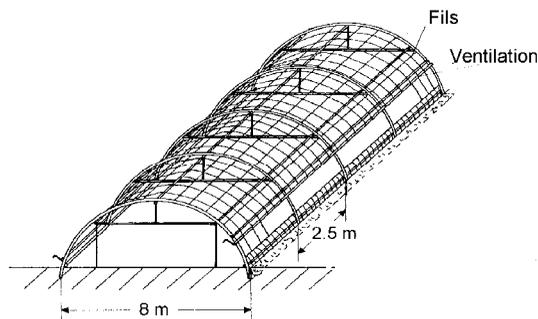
Tunnel de film plastique avec coupe transversale et ventilation latérale par enroulement (pratiqué également dans le bi-tunnel)
